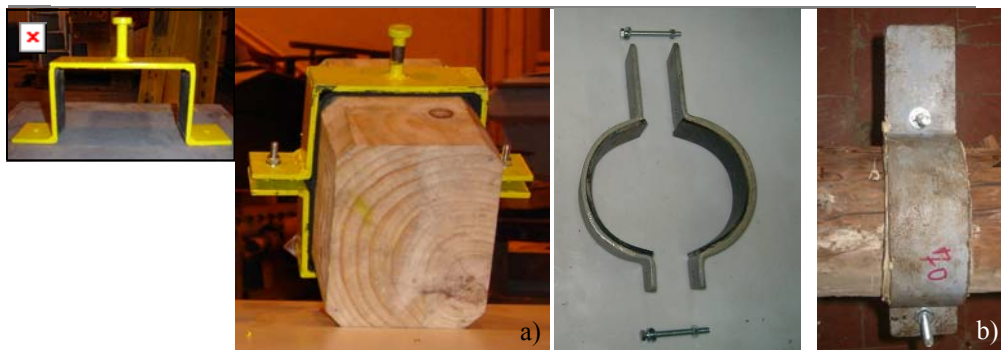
a) Manicotto per sezione rettangolare; b) Manicotto per sezione circolare.
